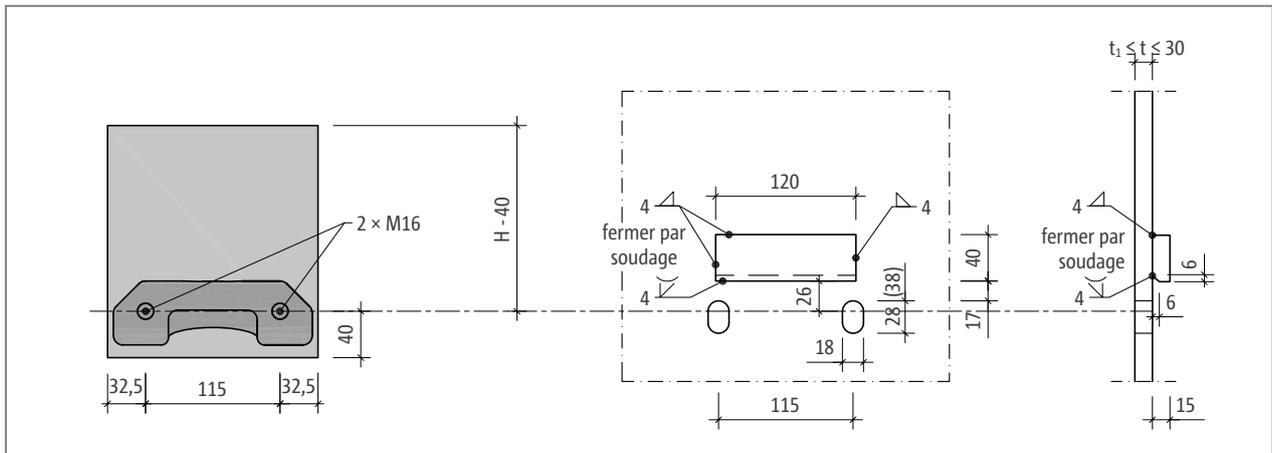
Schöck Isokorb® T type SQ : construction du raccordement de la plaque frontale
